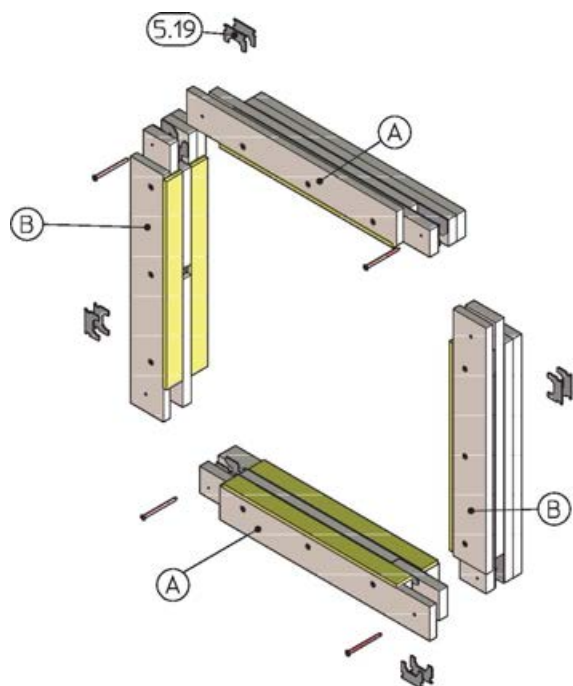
Kit d'installazione GM per installazione a secco – montaggio
